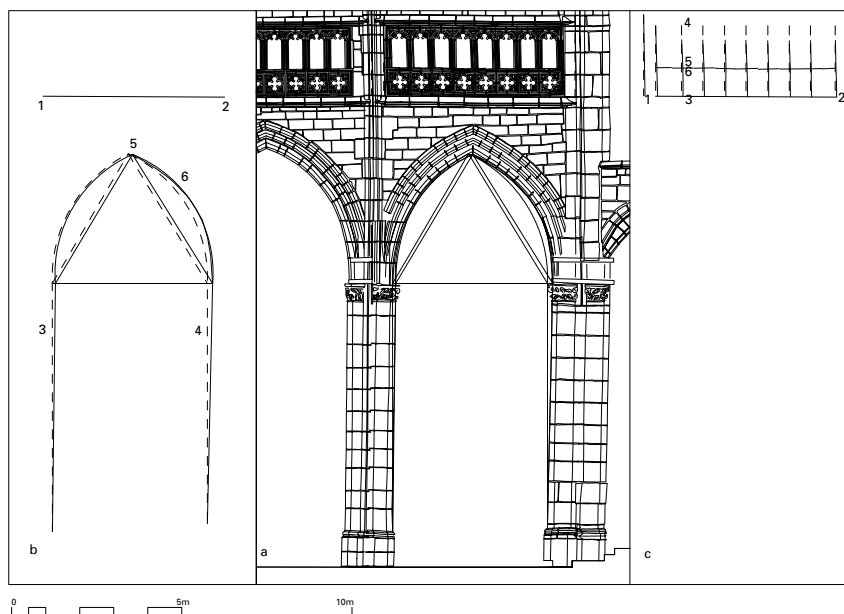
Alzado del muro norte del quinto tramo de la nave central.
